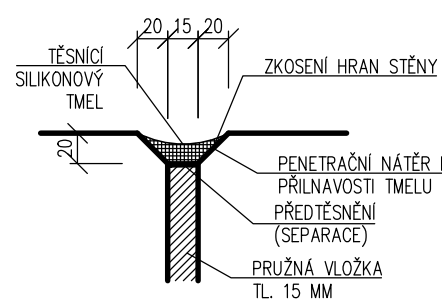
DETAIL A – DETAIL ZKOSENÍ HRAN STĚN
